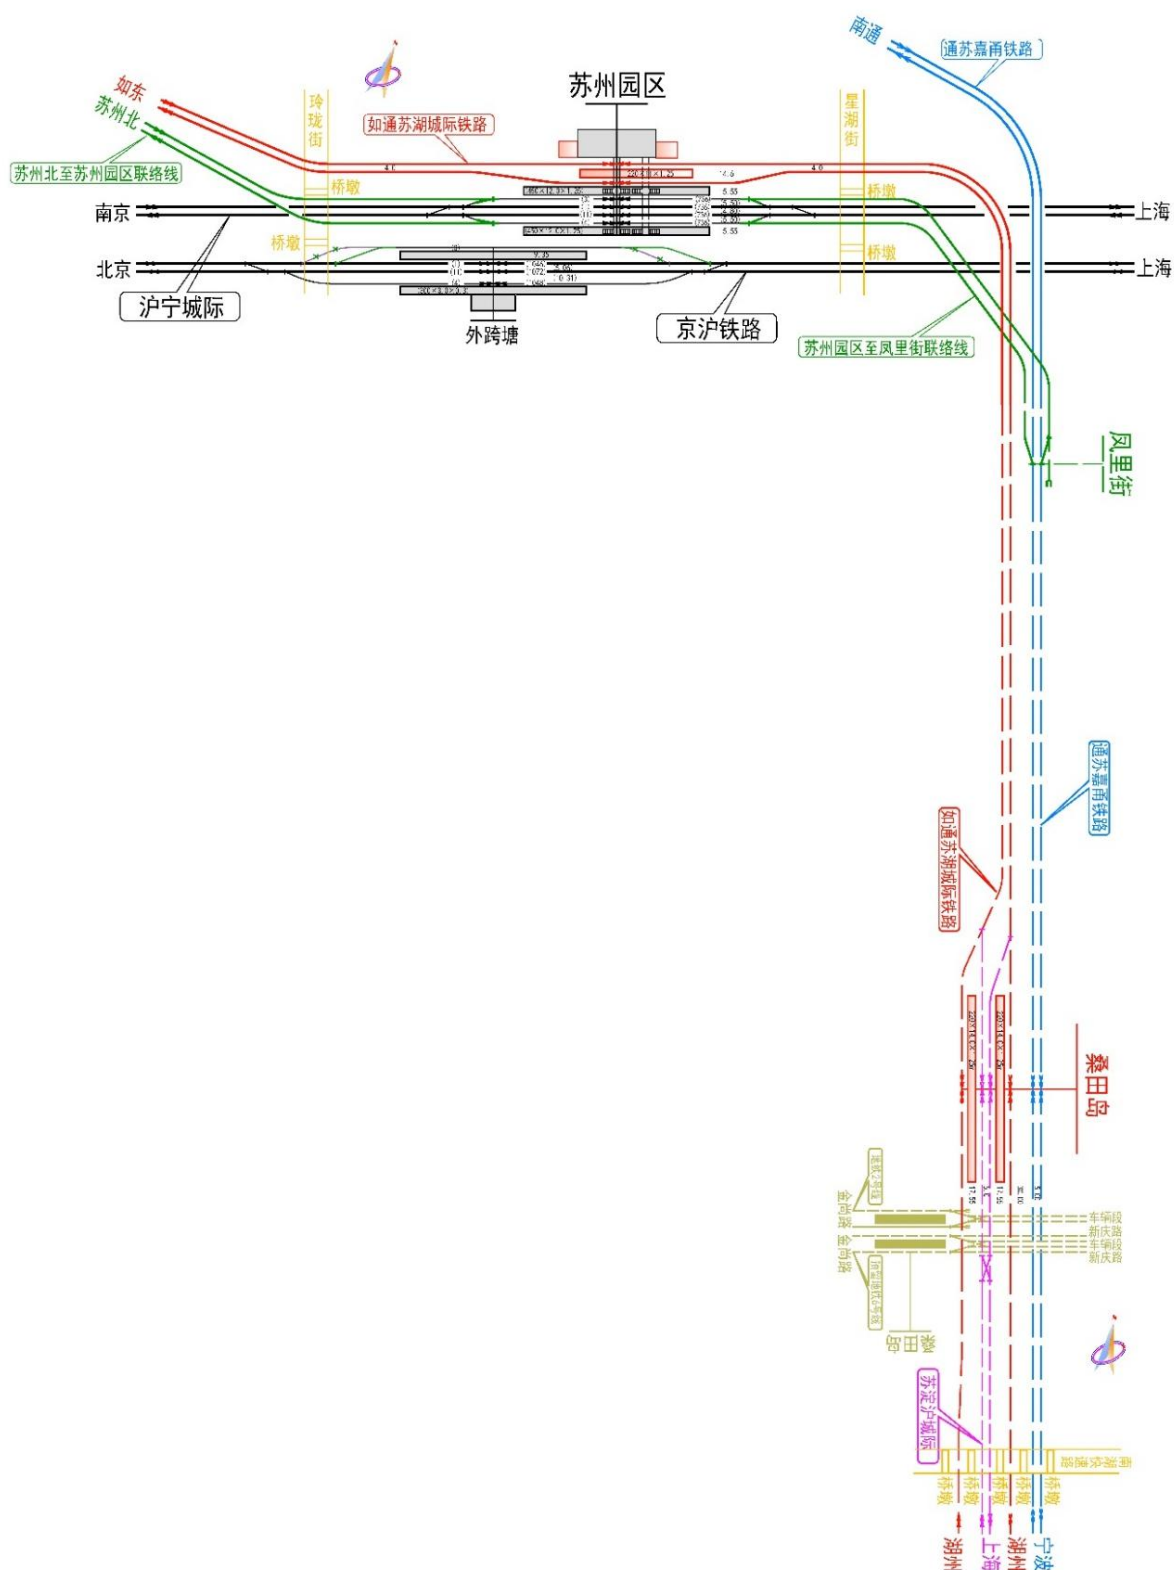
分线方案苏州园区站及桑田岛站平面布置示意图
